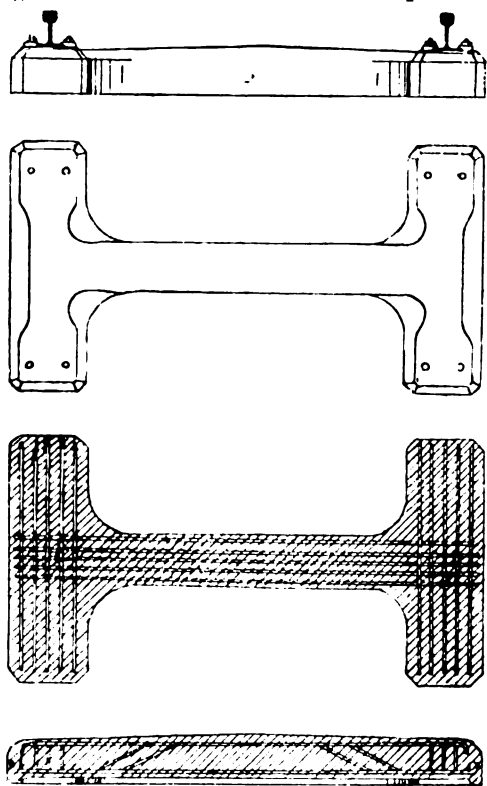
, 23, 24 e 25. — Elevazione, pianta e sezioni della traversa in cemento armato.
